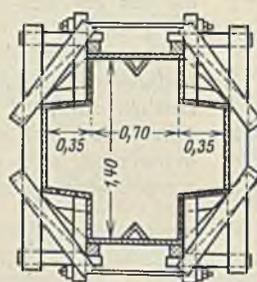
Fangdamm Beckholmen. Schalung der Pfeiler.
